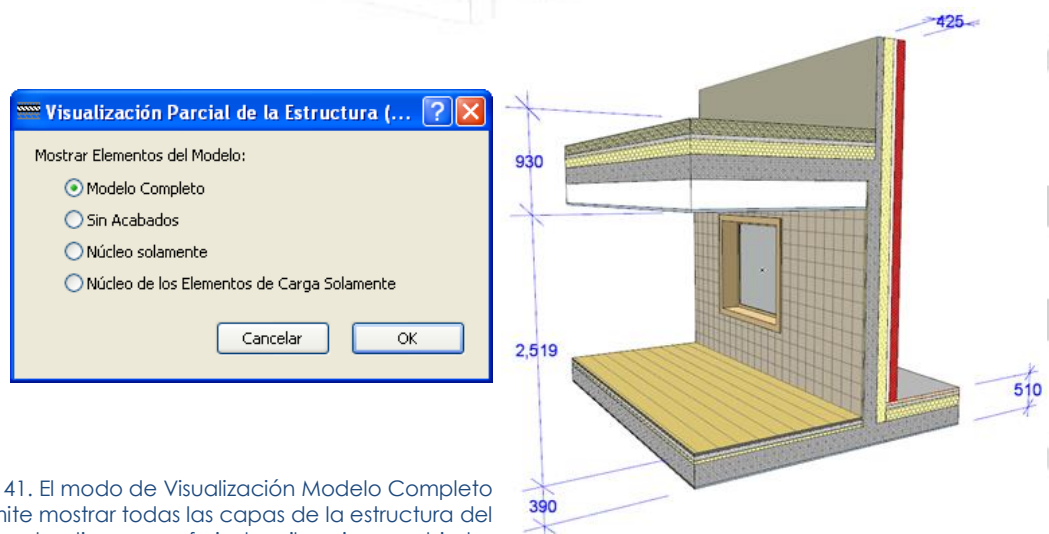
El modo de Visualización Modelo Completo permite mostrar todas las capas de la estructura del elemento constructivo: muro, forjado, pilar, viga y cubierta.
